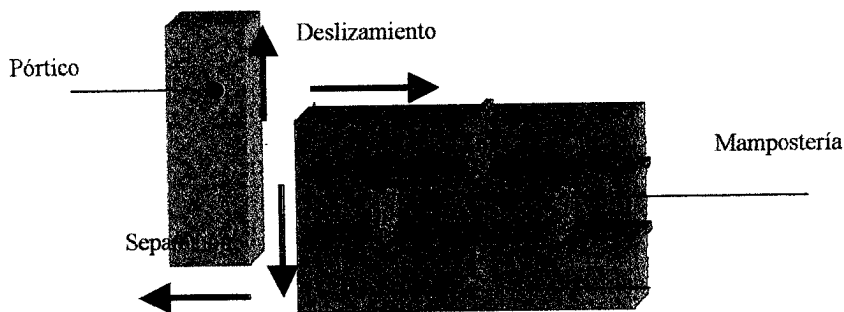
Separación y deslizamiento entre pórtico y mampostería.
